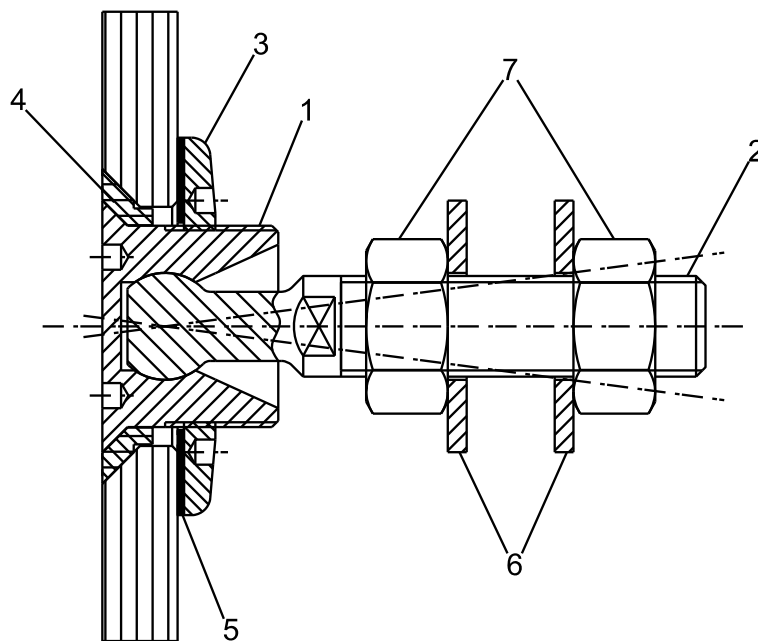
Coupe sur fixation traversante pour vitrage POINT S type 50/38
